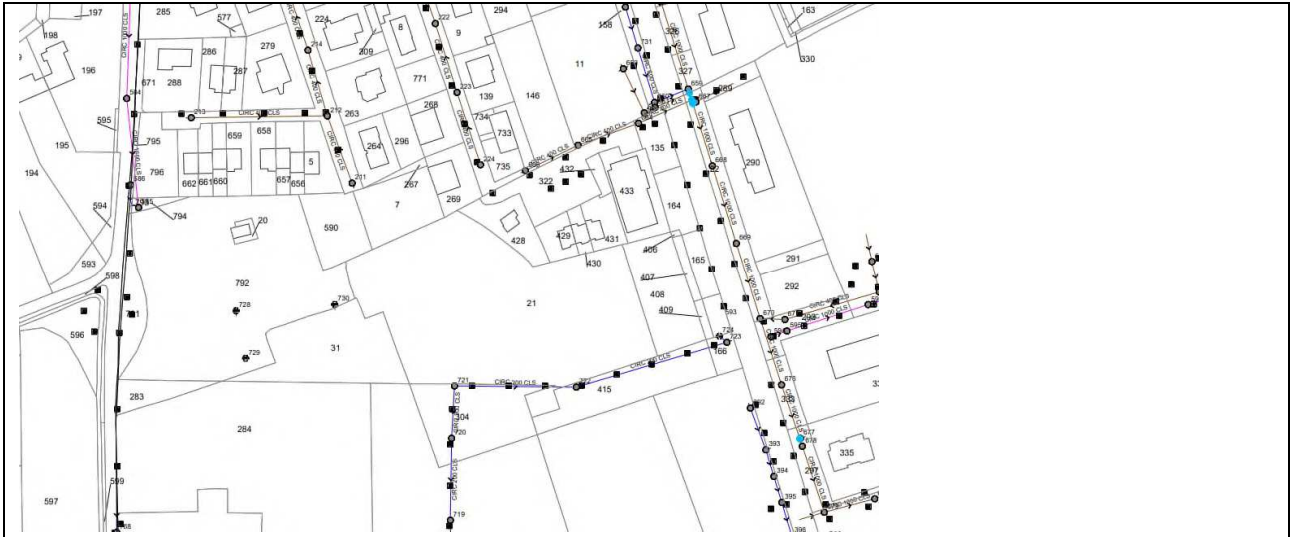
Planimetria catastale dell'intervento Lotto n.1, collettore in parco
